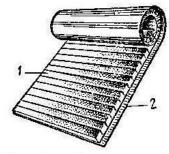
Минераловатный вертикально-слоистый мат: 1 — минераловатные полосы, 2 — защитьо-нокровный материал
